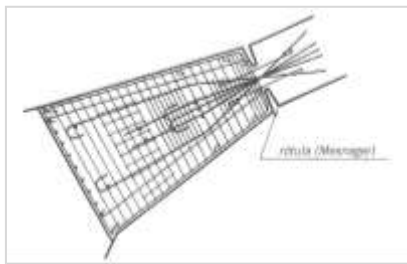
Rótula de Mesanger en estructuras de puentes de hormigón armado. En: Eduardo Torroja, Razón y Ser de los Tipos Estructurales, Madrid, 2010, p. 71.
